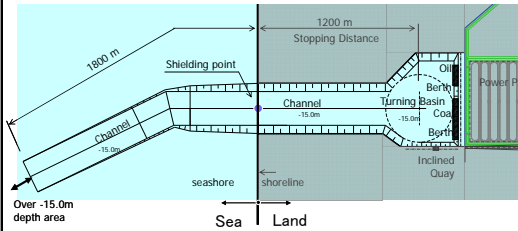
Plan B: 配置図 (Excavated Port Type)
